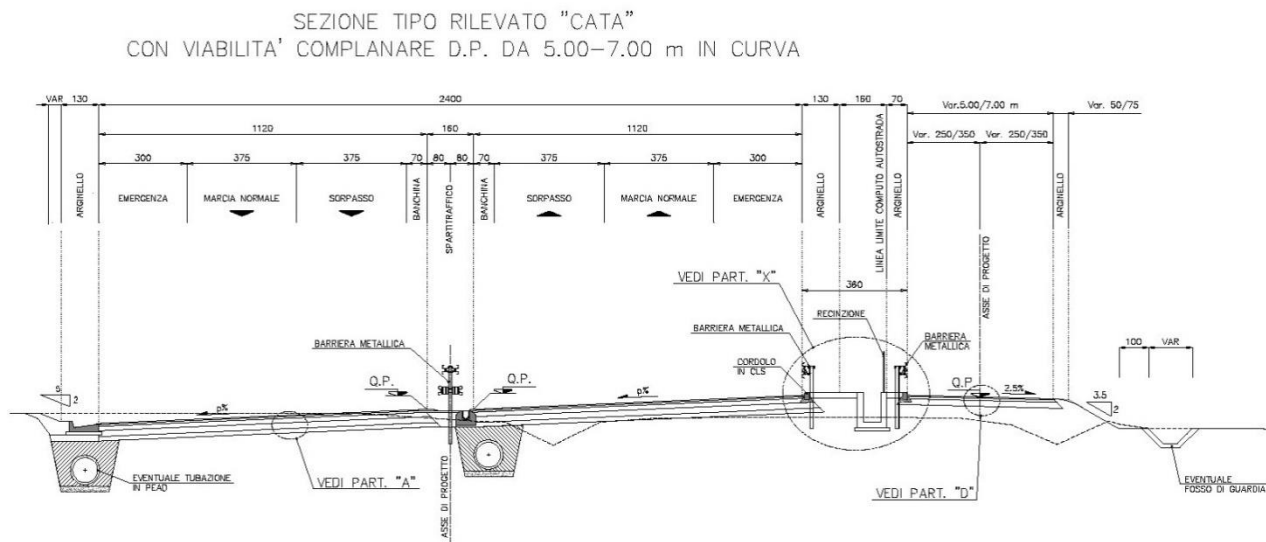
Sezione tipo di progetto con viabilità secondaria in complanare (adeguamento SS1 Aurelia)
